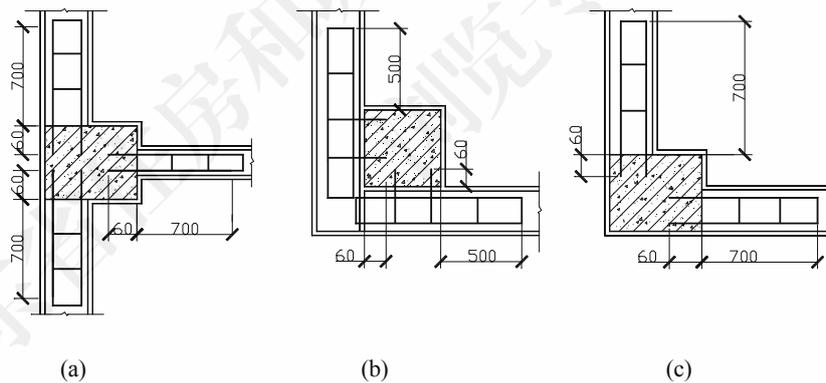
砌块墙体与钢筋混凝土柱的连接示意图
